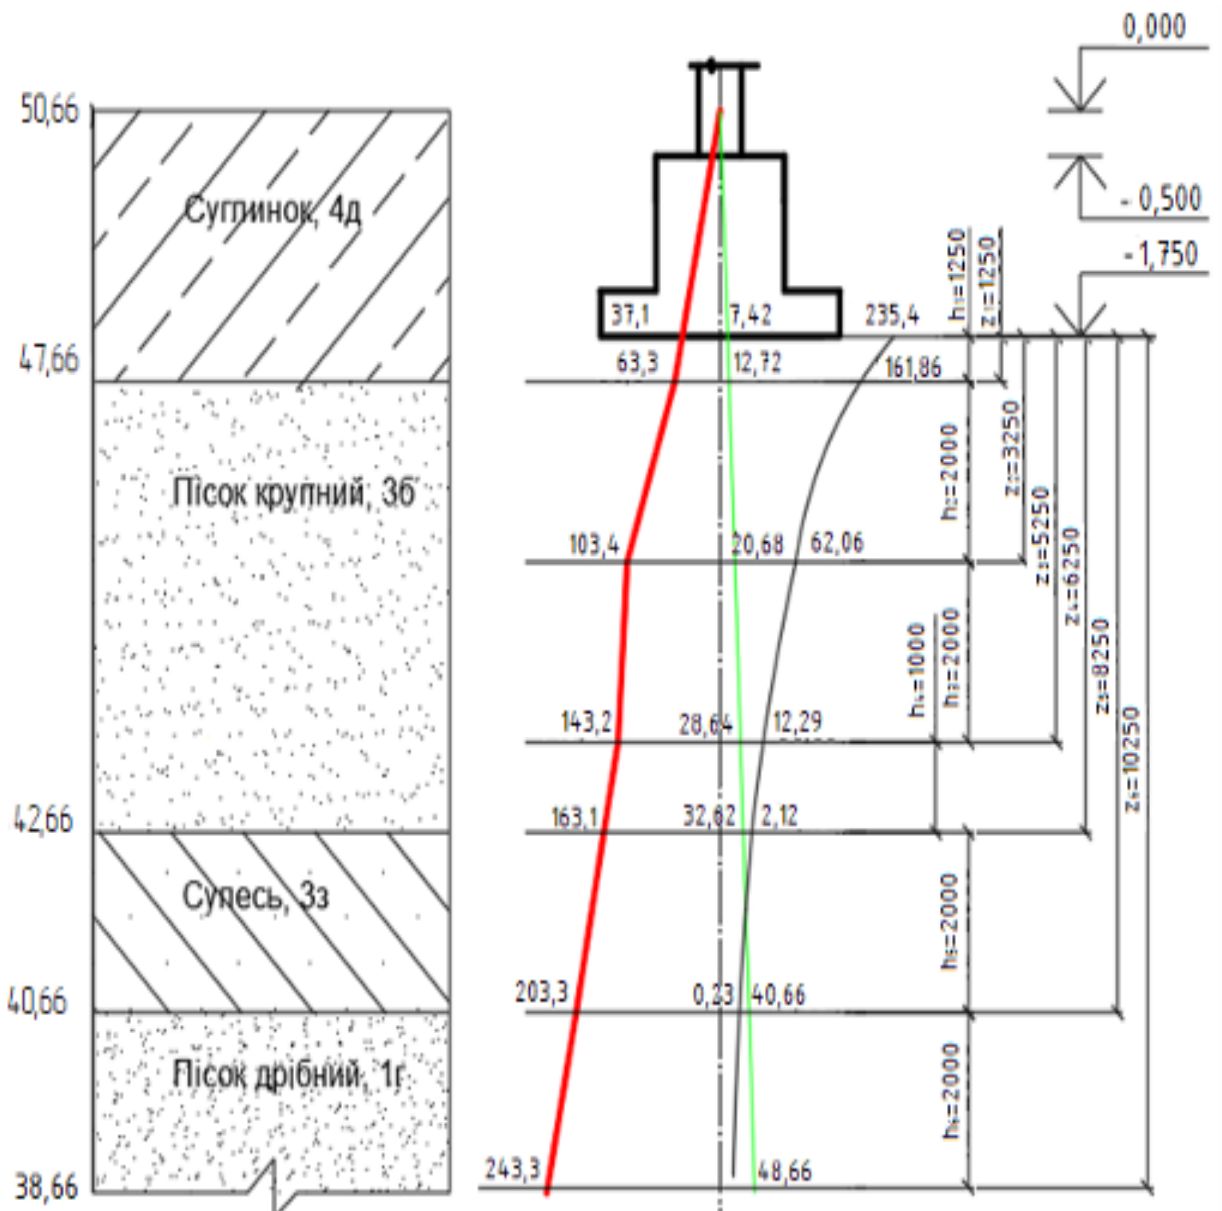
Схема для розрахунку осідання фундаменту
